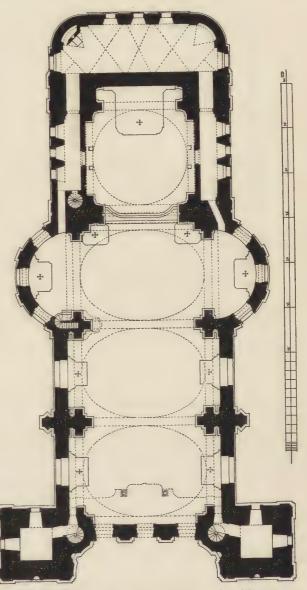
St. Jacobskirche zu Innsbruck. Grundriss.
